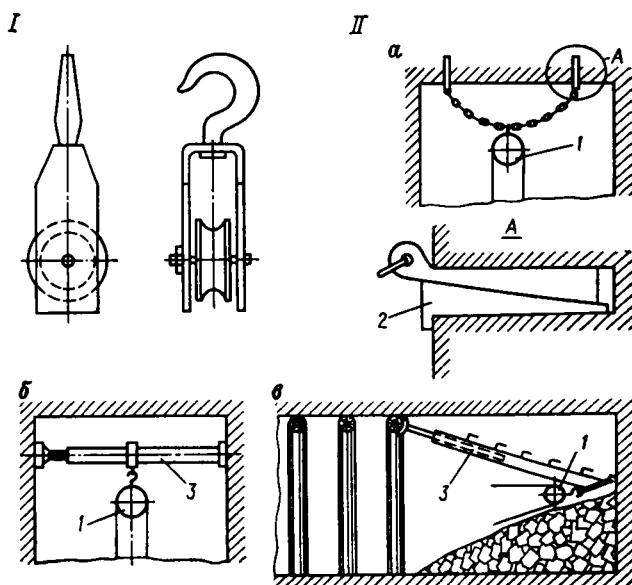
Общий вид блока (I) и схема закрепления скреперных блоков (II):
